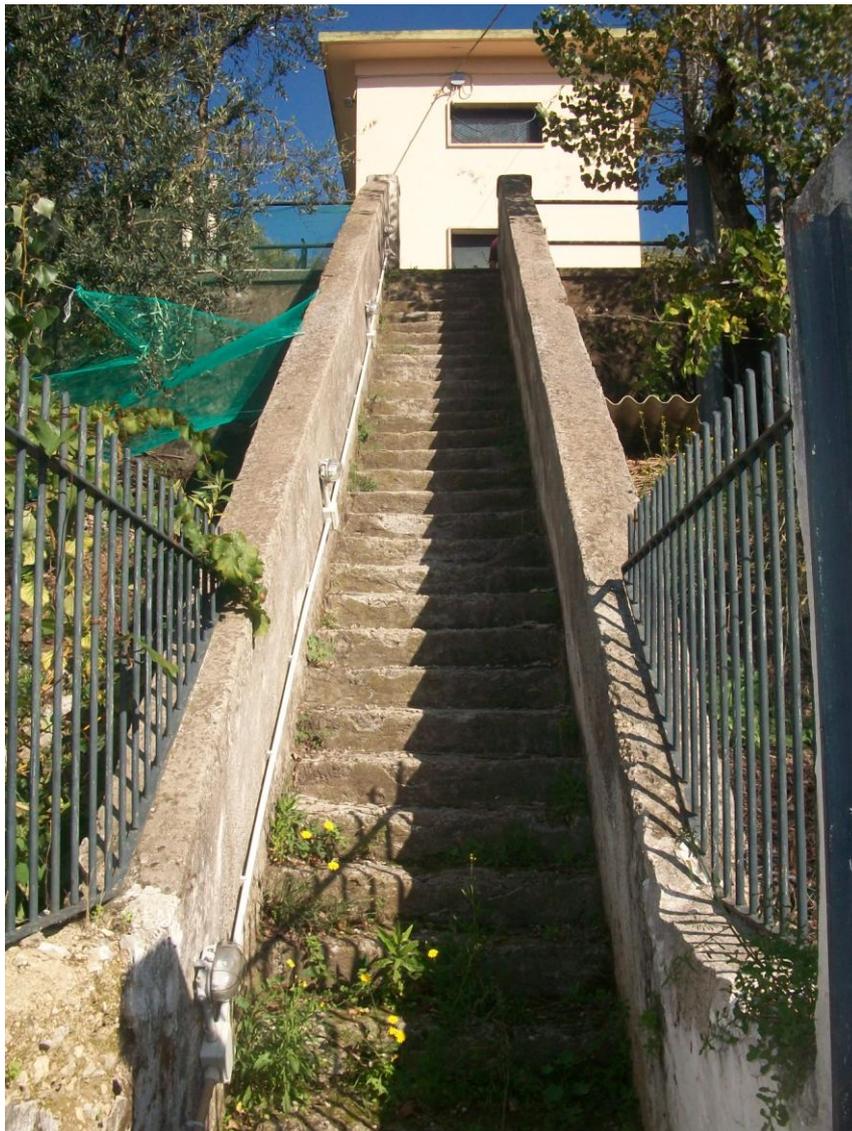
Serbatoio Casola Basso – Particolare pista di servizio: scalinata
